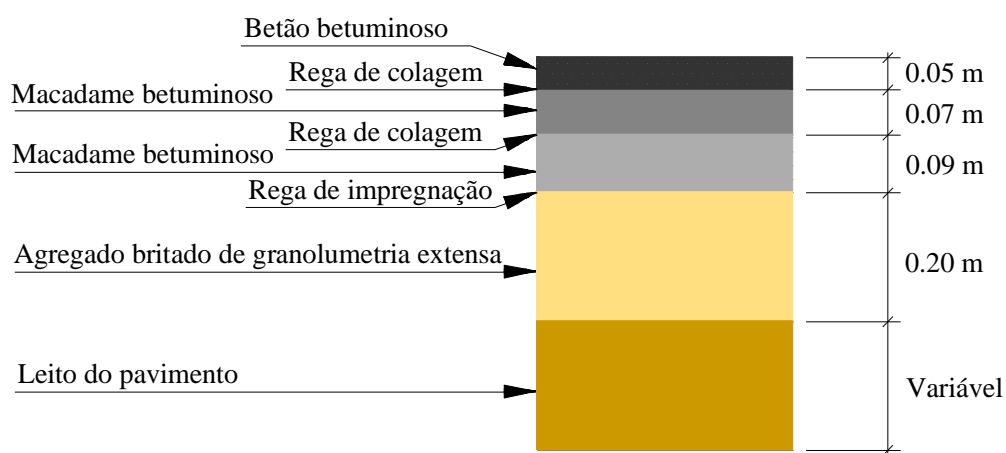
Estrutura do pavimento no centro da via (Projecto de execução do troço do IC9 – Sublanço Alburitel / Nó de Carregueiros).
